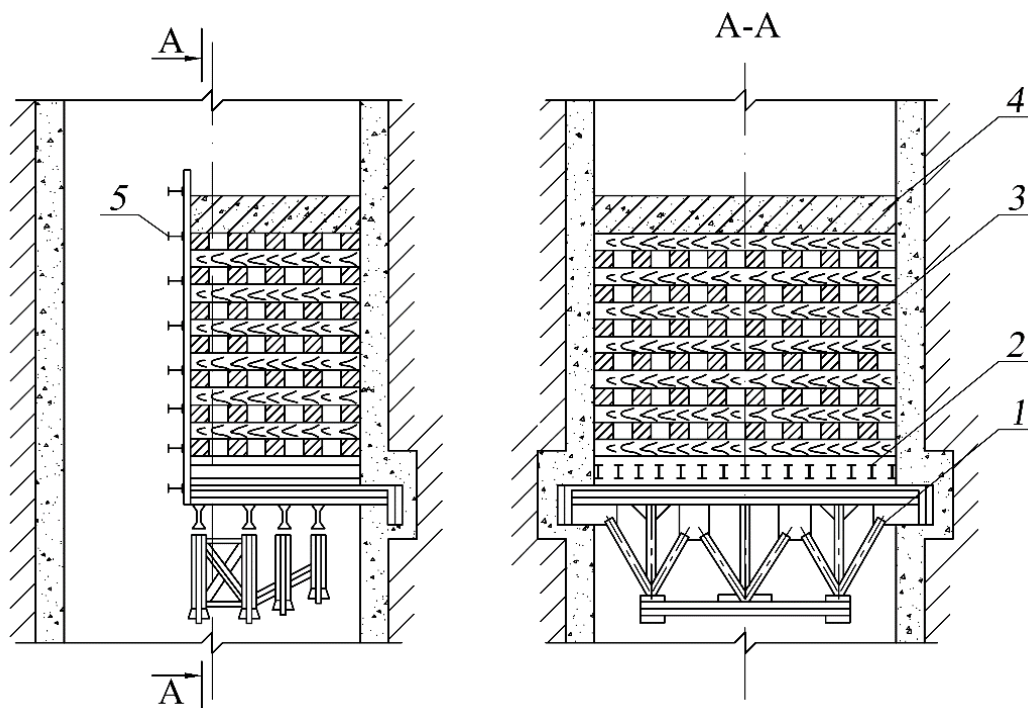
ПП с ферменной несущей конструкцией: 1 – несущие фермы; 2 – настил из балок;
